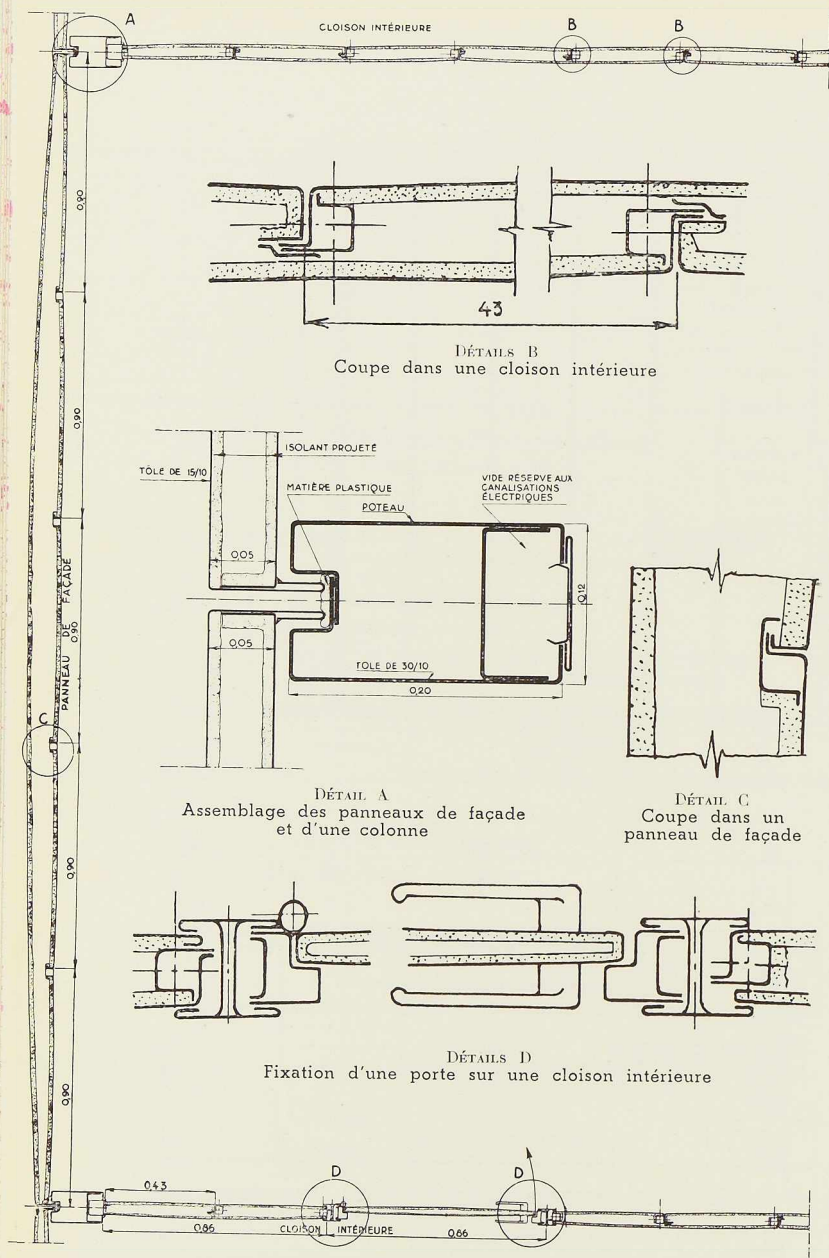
Coupe horizontale dans une paroi extérieure et deux cloisons intérieures. Détails d'exécution.
